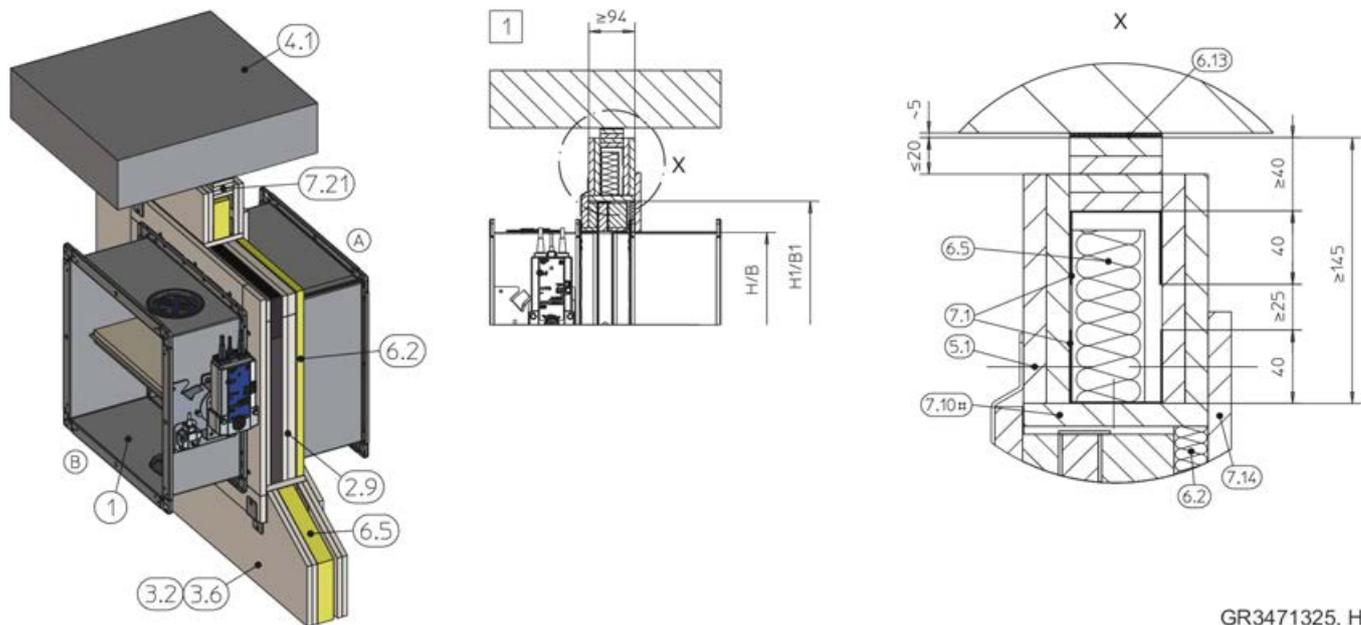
Installazione senza muratura in una parete divisoria leggera, sotto un collegamento flessibile al soffitto
